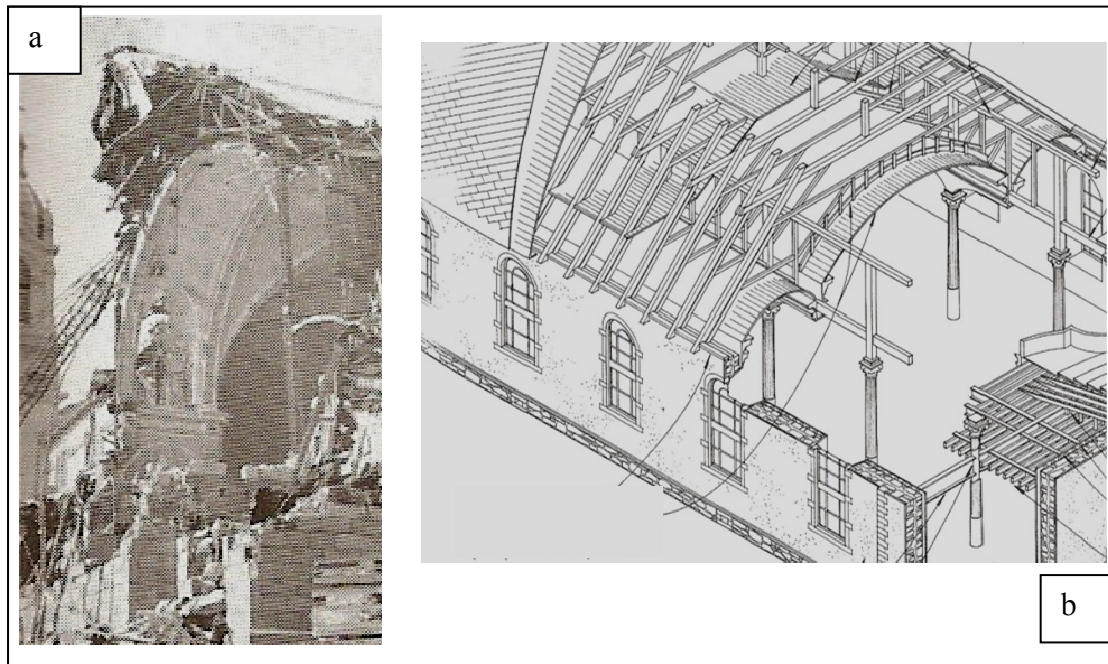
Détails architecturaux d'une arche non structurale : a) église en démolition, b) reconstitution de charpente
